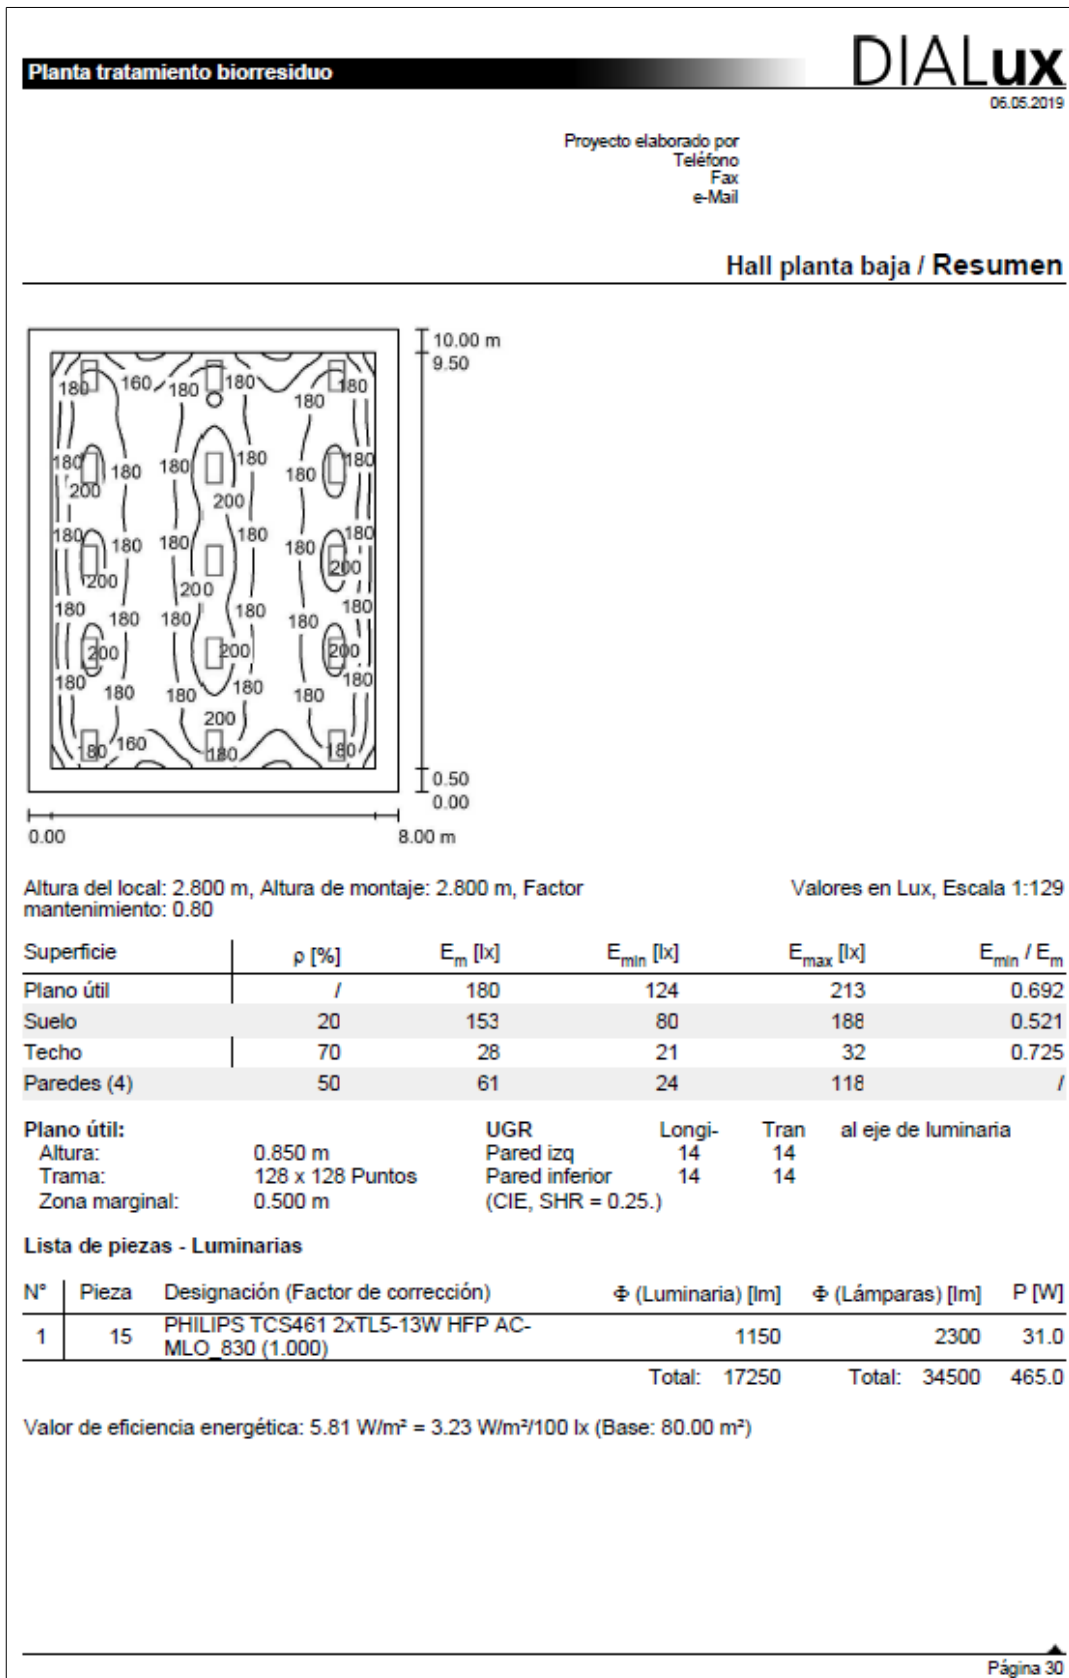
Cálculos lumínicos hall planta baja. Fuente: DIALUX.
